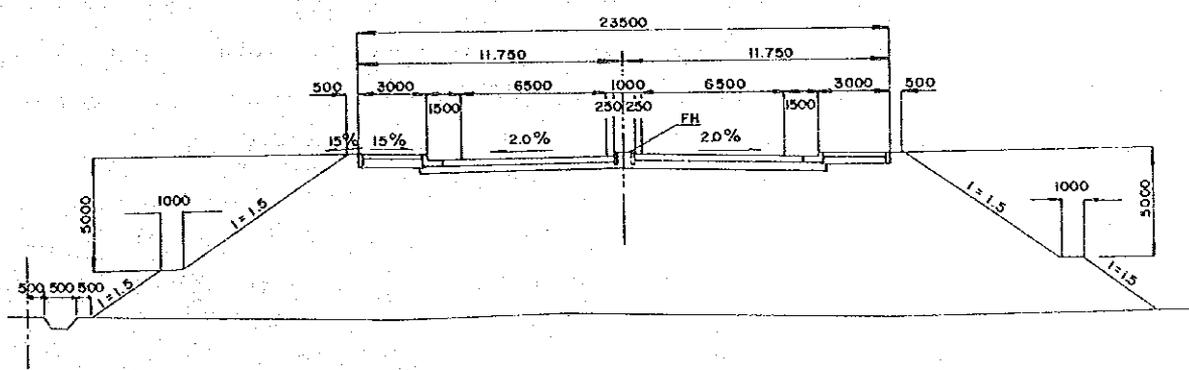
SECCION DE CONSTRUCCION DE AVENIDA DEL RIO
